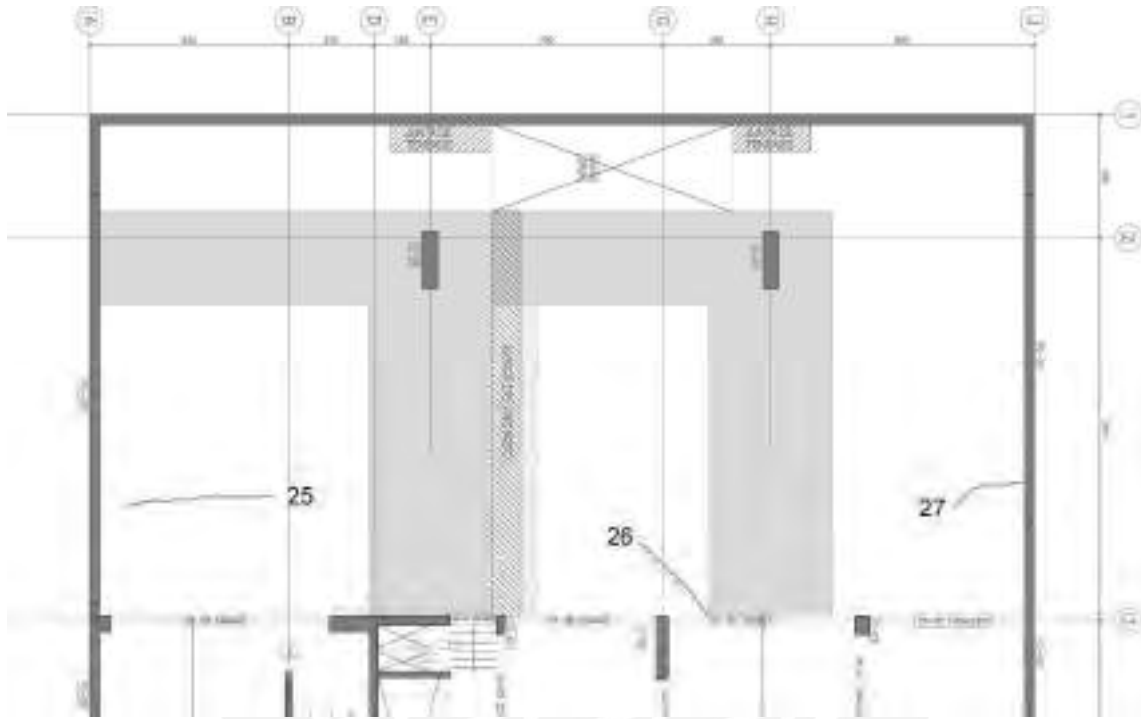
Ubicación de fisuras en semisótano 7
